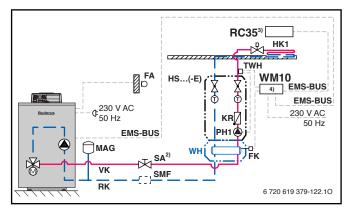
Esempio di un riscaldamento a pavimento non direttamente asservito
